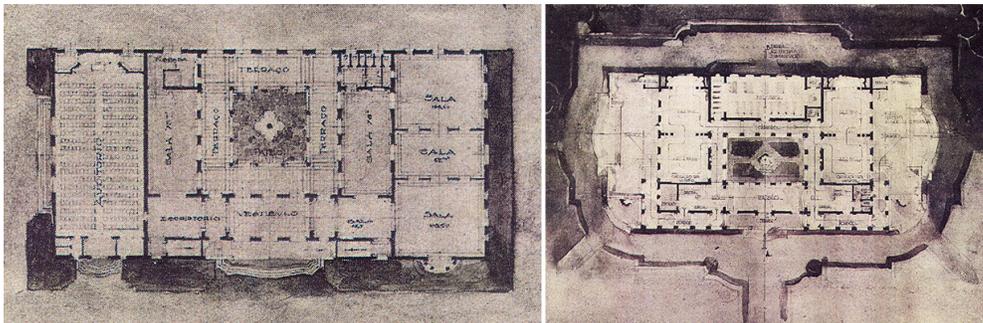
Plantas baixas do pavimento principal dos projetos de Nereo Sampaio e Lucio Costa para o pavilhão do Brasil na Exposição da Filadélfia.
